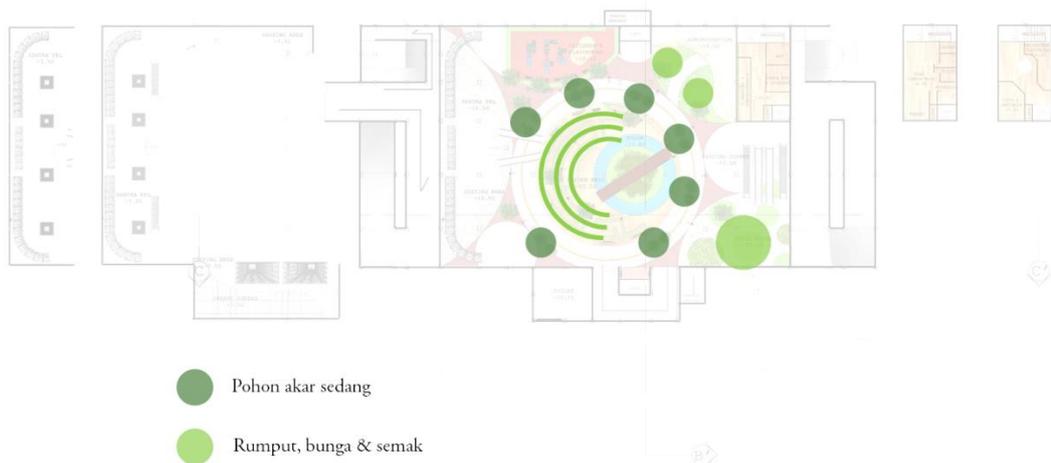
Peletakan elemen softscape dalam site plan
